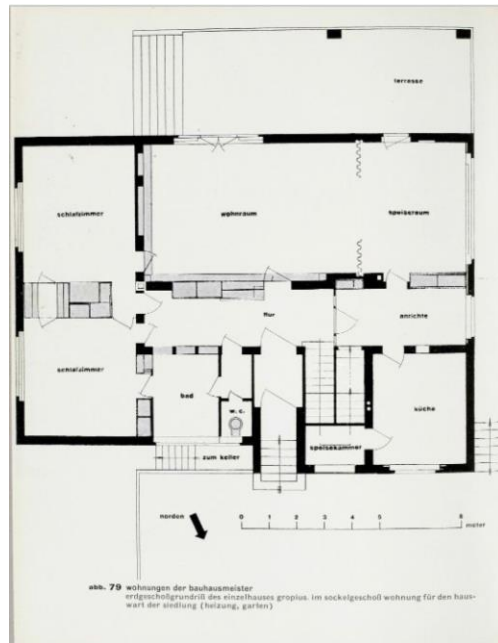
Ilustración del plano de la planta baja de la Casa del Director en Dessau (Gropius, 1930, p.90)
